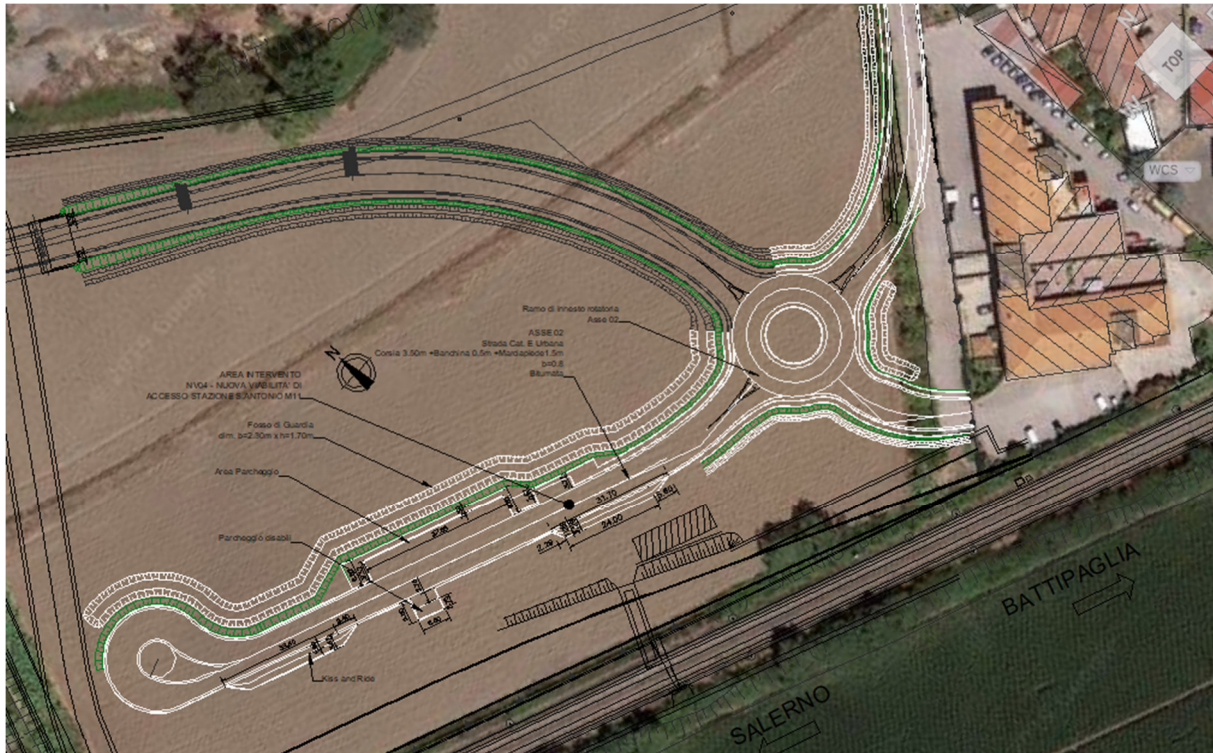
Stralcio planimetrico – NV04_Nuova viabilità di accesso alla Stazione M11
